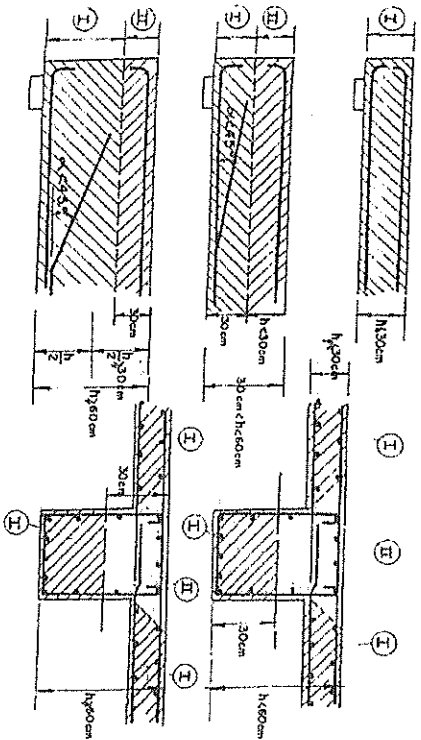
Barras em situação de boa aderência e em situação de má aderência
